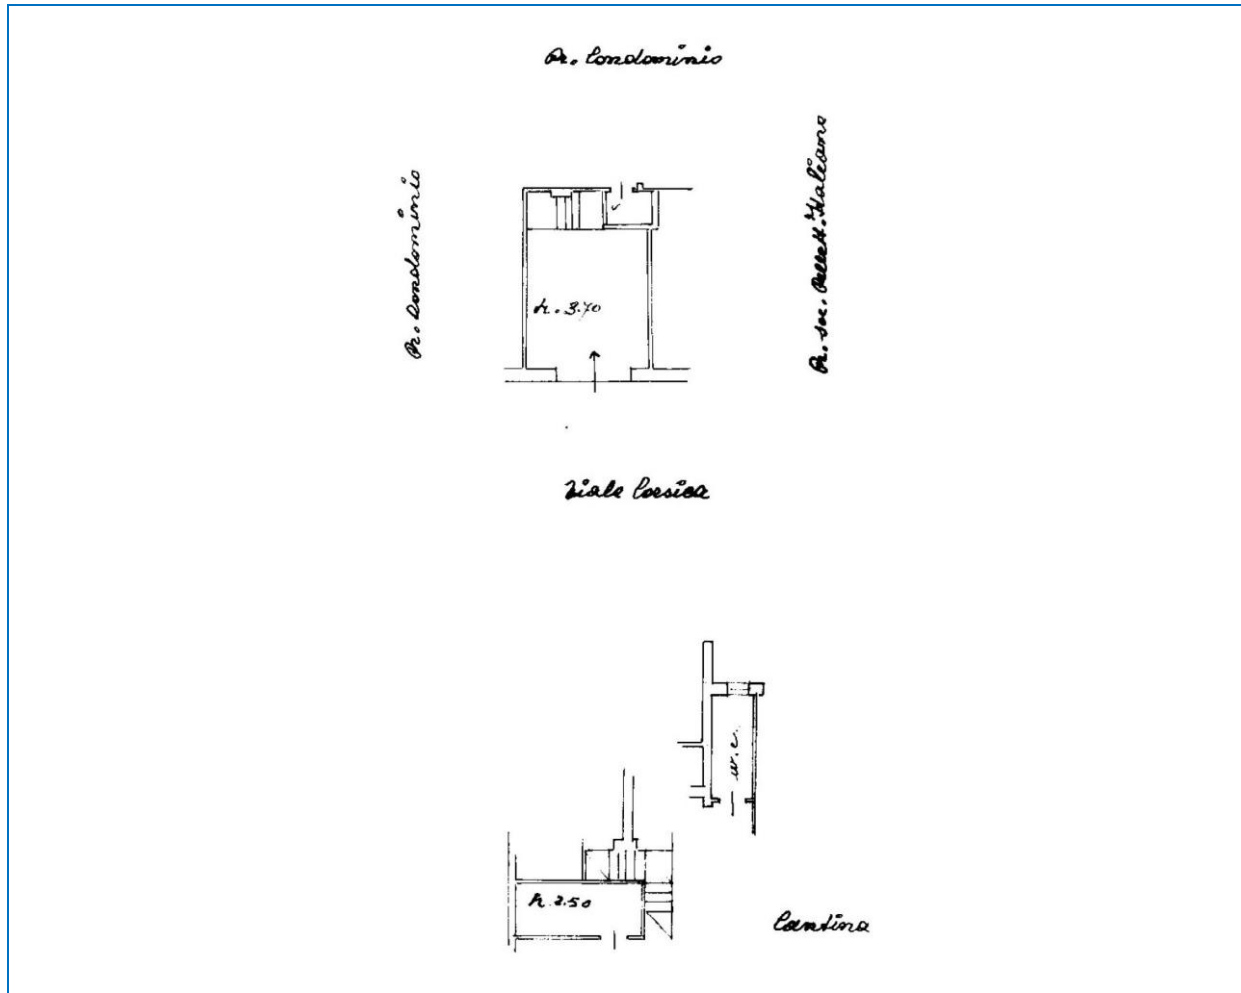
estratto planimetria catastale del negozio sub. 1 - piano T - S1
